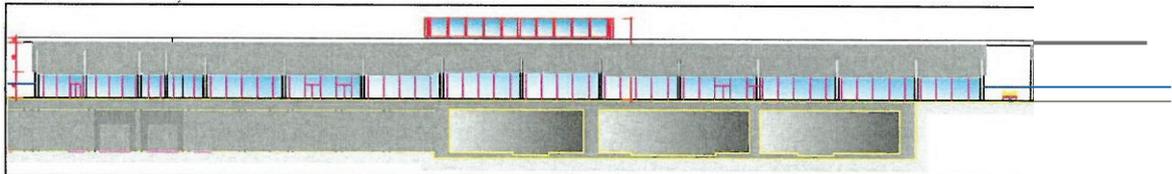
Figura 5 - Stazione internazionale - prospetto sud
